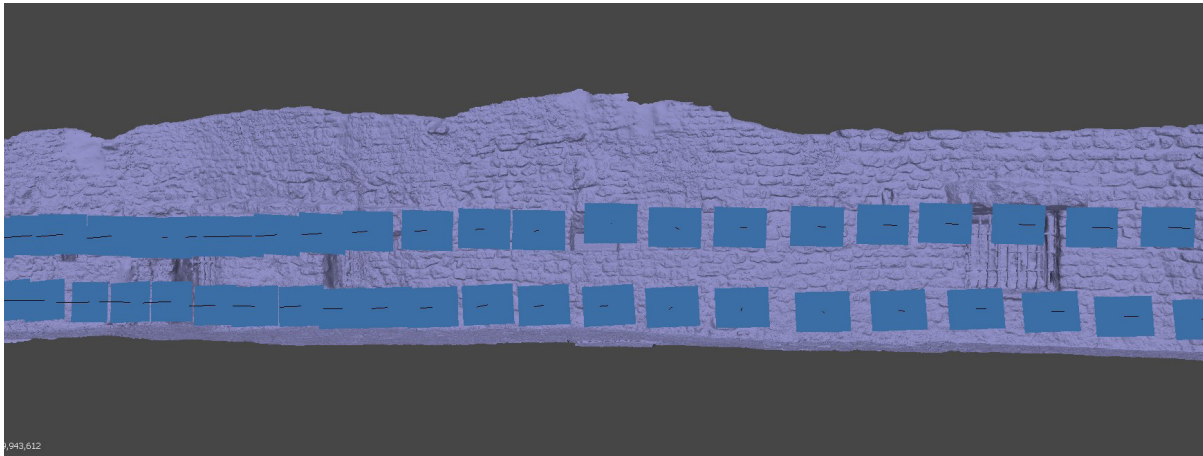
Levantamiento de la fachada rehabilitada. Modelo sólido y posicionamiento de cámaras. Fuente: Elaboración propia
